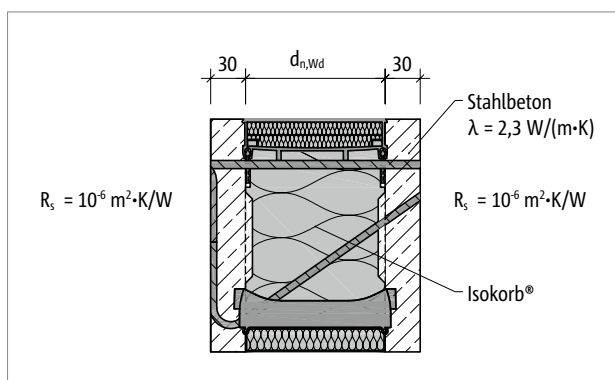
Komplexes Produkt Schöck Isokorb®; zwischen zwei Betonplatten betrachtet
